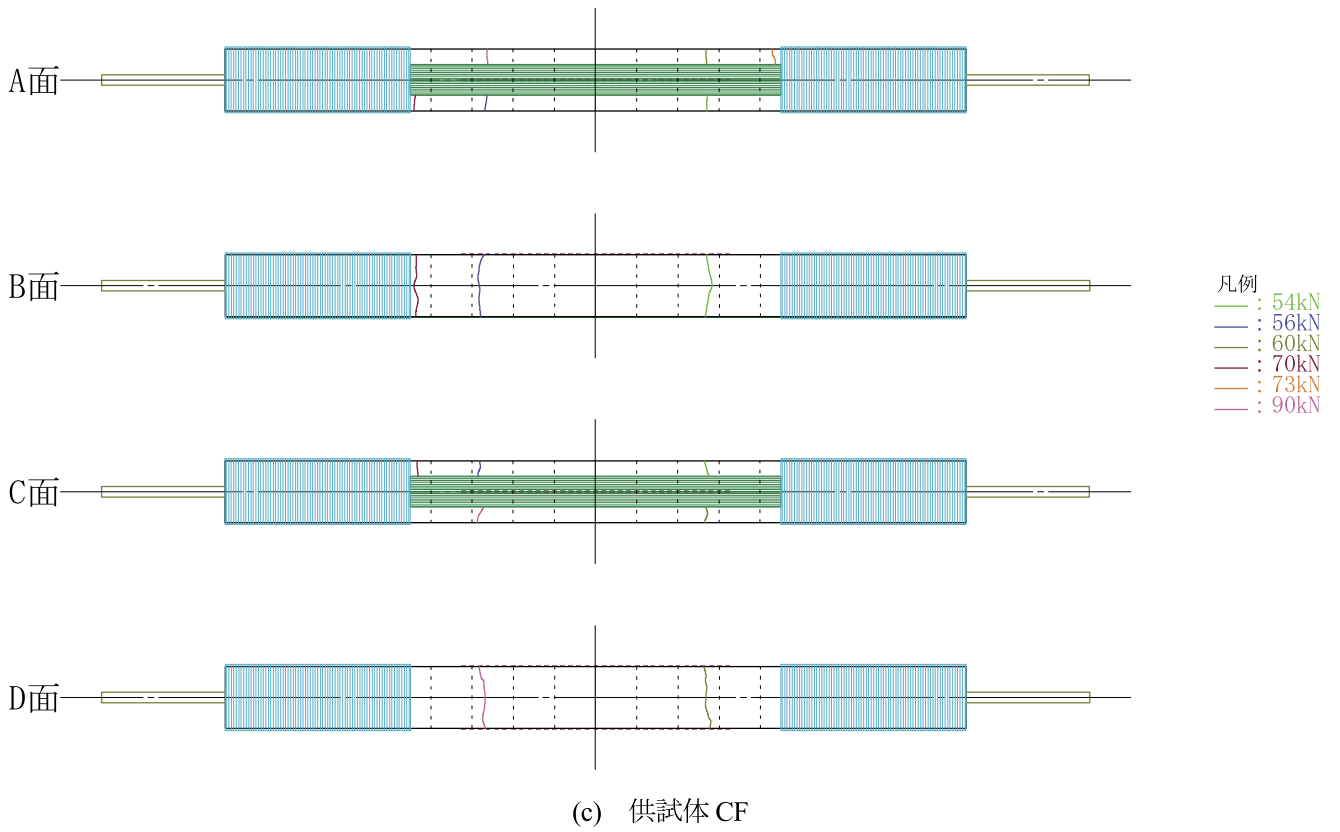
鉄筋降伏前におけるコンクリートのひび割れ発生状況 (つづき)
